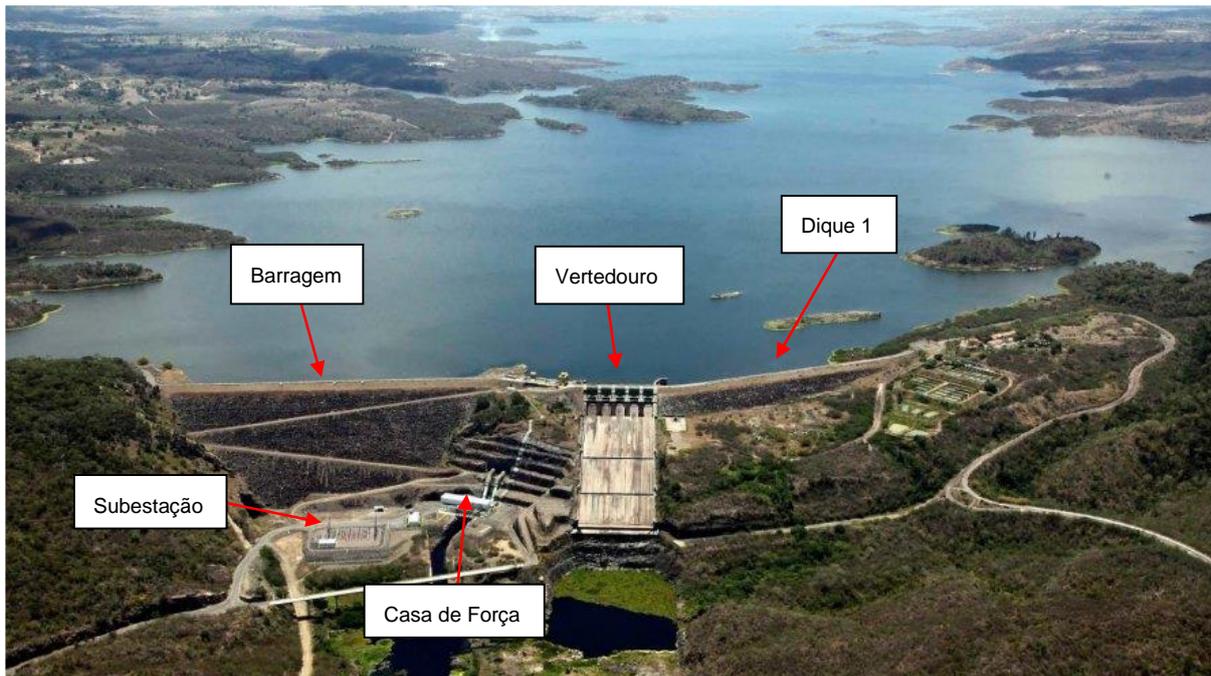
Vista Geral da barragem Pedra do Cavallo.
